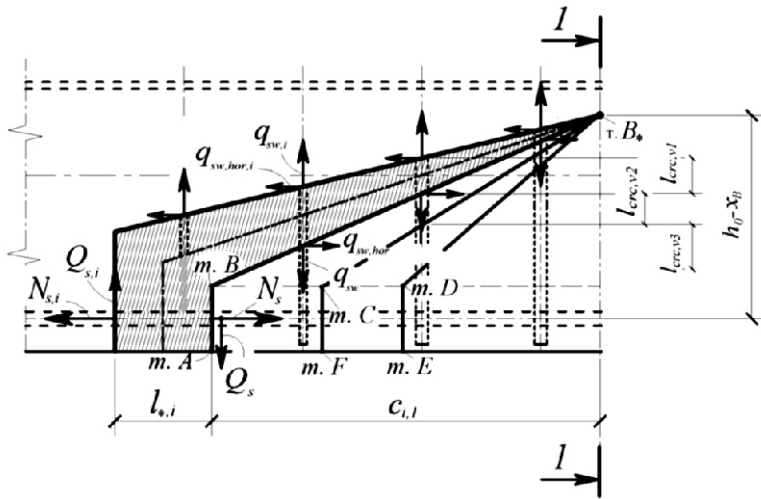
Расчетная модель для определения усилий в продольной и поперечной арматуре в трещинах, образующих веер 1, прилегающий к сосредоточенной силе
